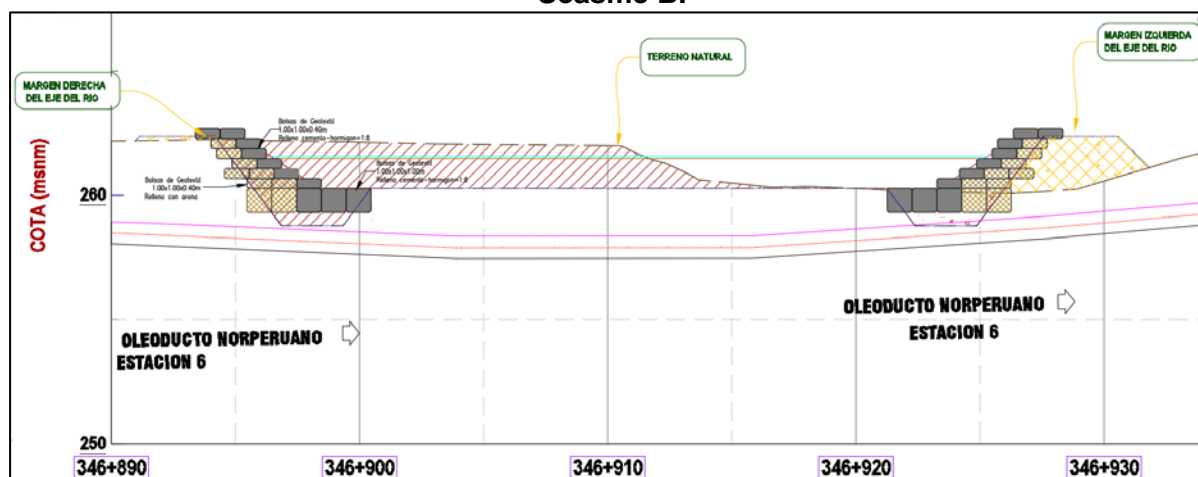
Detalle de relleno de zanja para tubería ONP.
